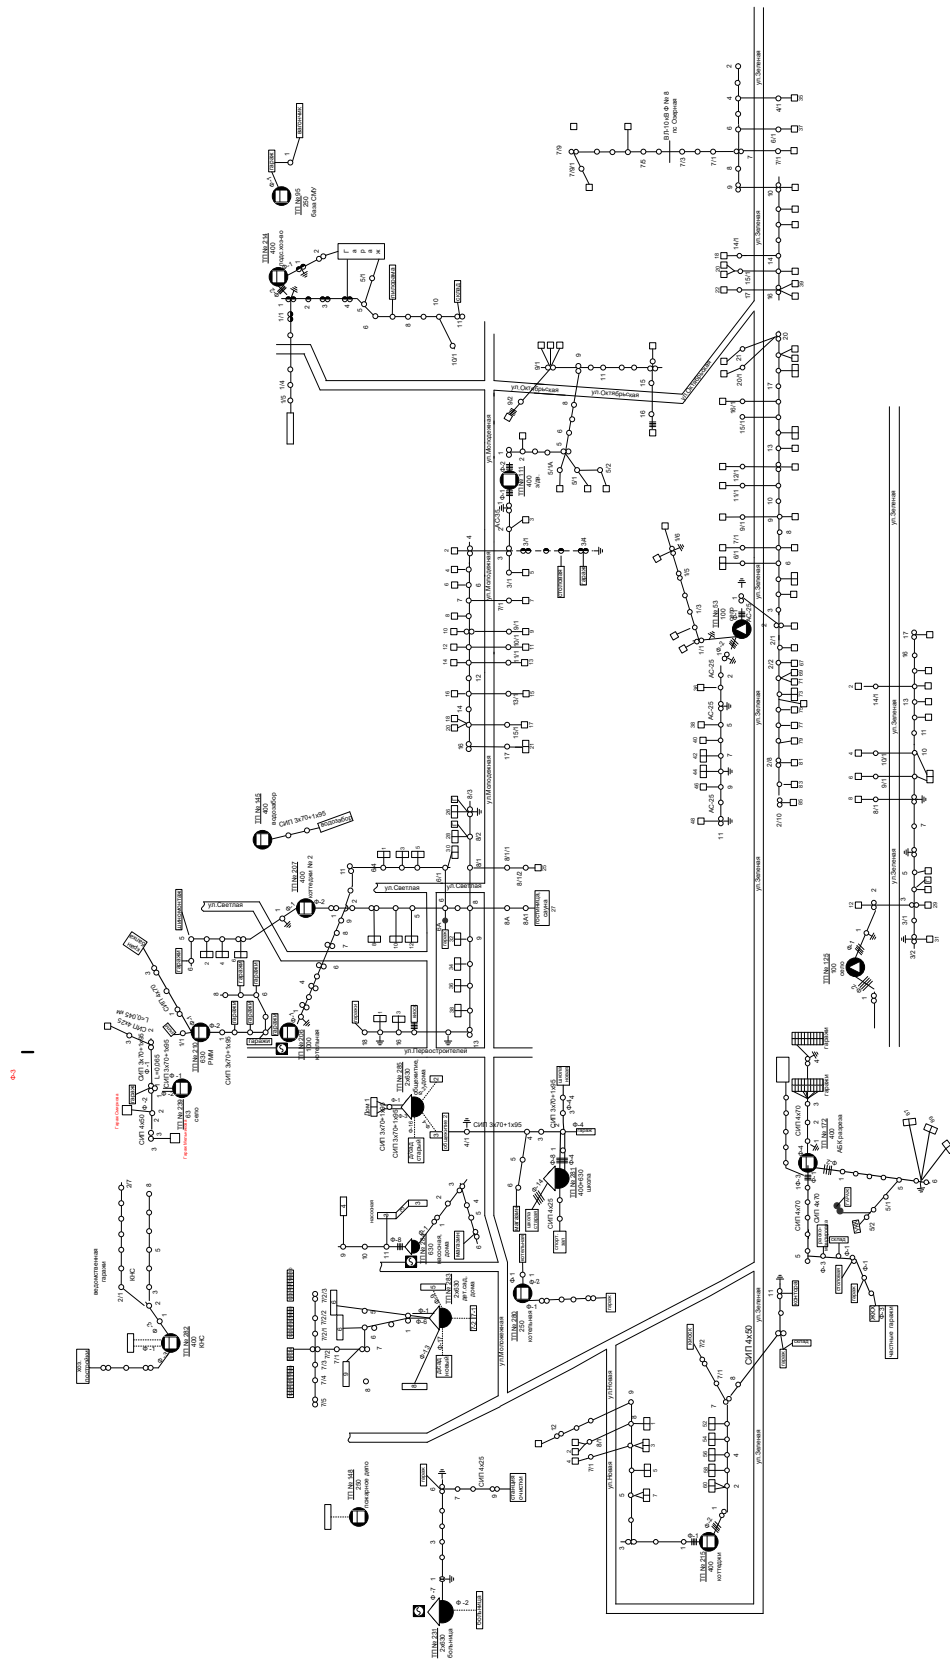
Схема 0,4 кВ села Варваровка до реконструкции
